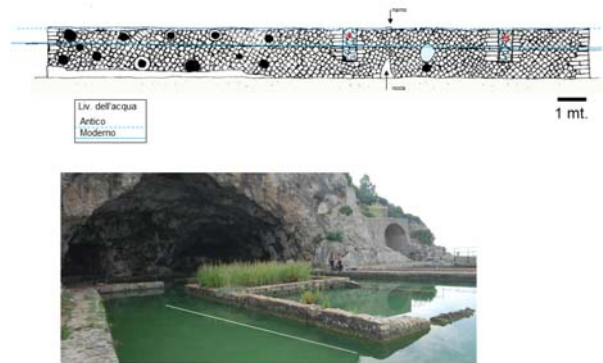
Il muro perimetrale N dell'isolotto (M. Stefanile)
